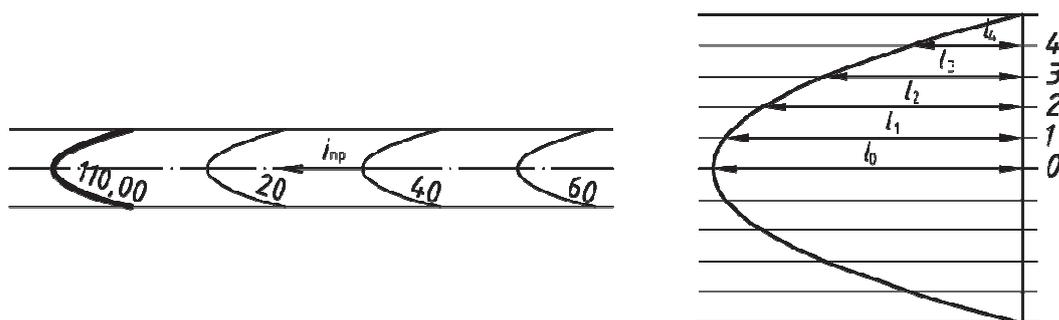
Схема вертикальной планировки садово-парковой дорожки с параболическим поперечным профилем
